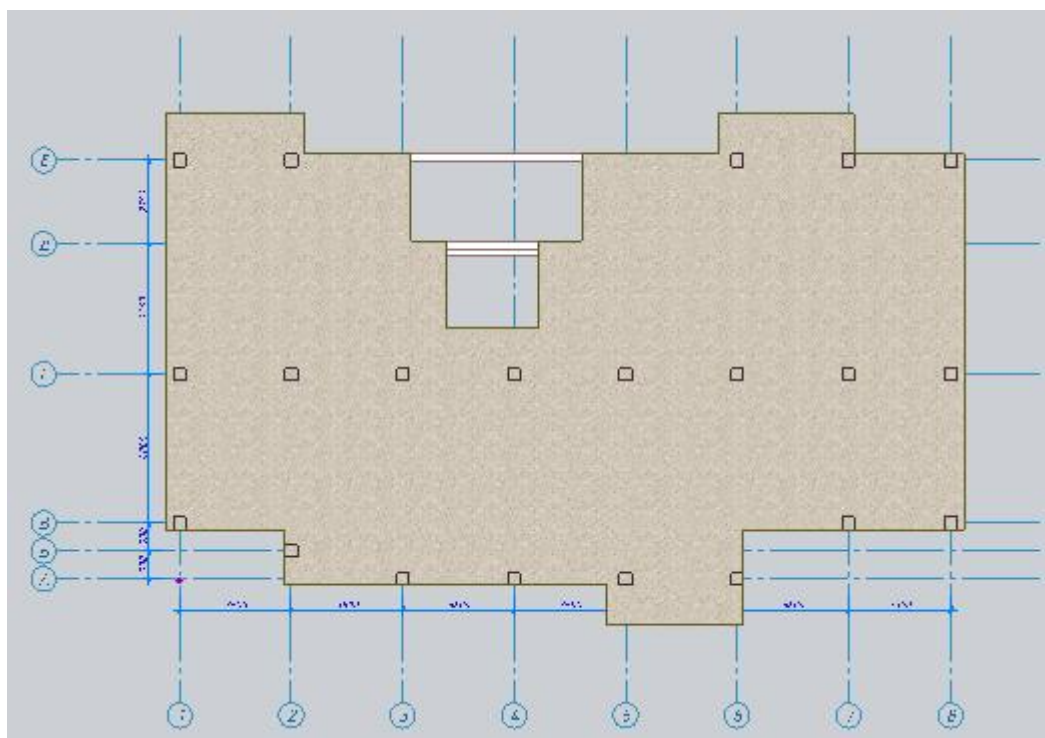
Монолитное перекрытие в плане
